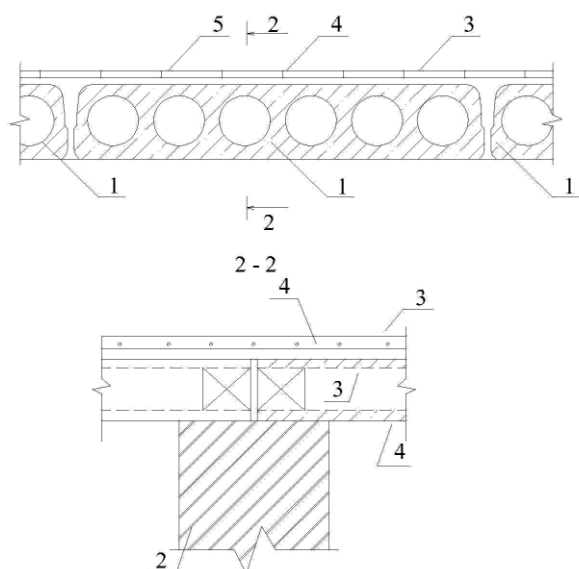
Нарощування плит зверху при забезпеченні зчеплення поверхні: 1 – підсилювані плити; 2 – опора (блок або балка); 3 – монолітний шар бетону; 4 – арматурна сітка підсилення; 5 – поверхні зчеплення монолітного бетону з плитами (зачищення, насікання, промивання водою)
